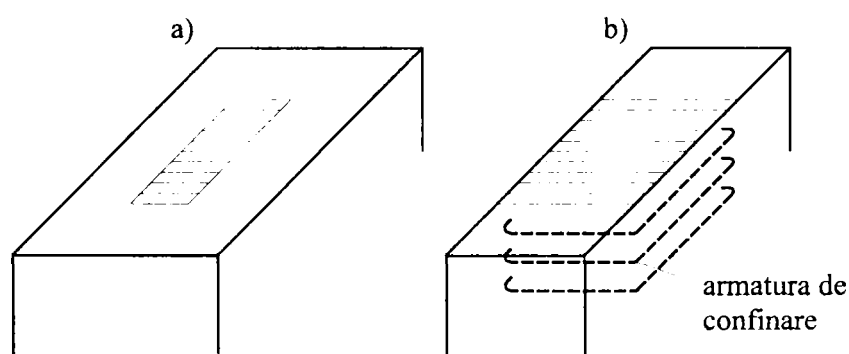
Zone de beton confinate cu armătură suplimentară [39]
